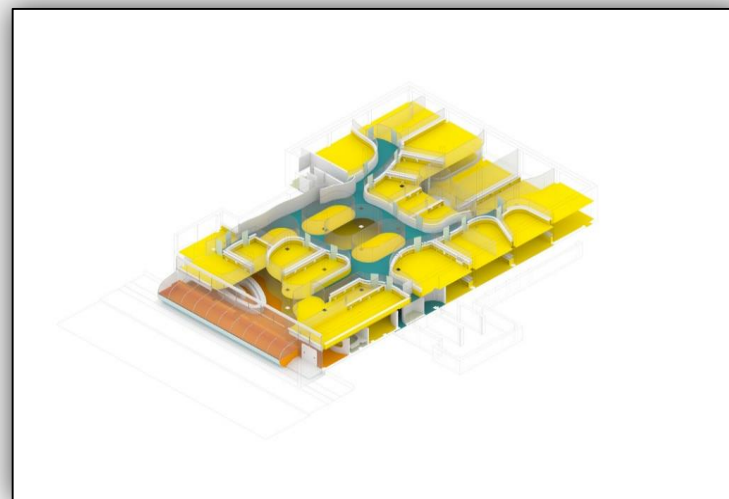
2º Pavimento Fonte: archdaily.com.br
